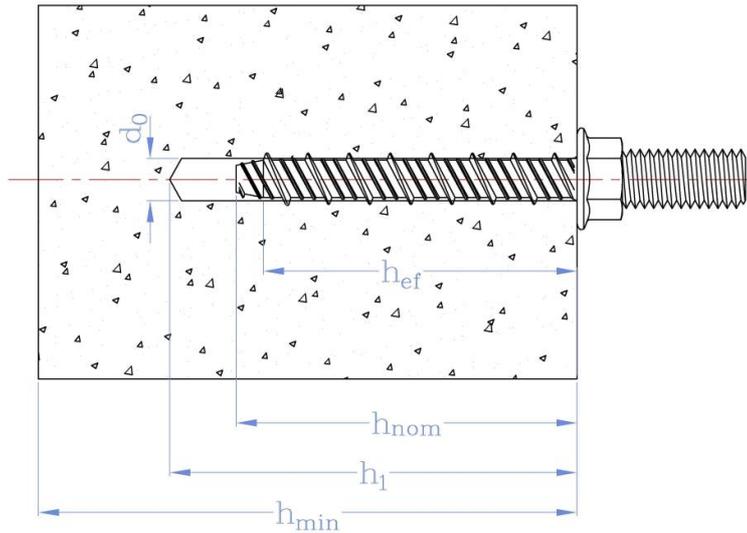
Condiciones de instalación para anclajes SSD, SSI, SSF, SSO, SSU, SSG, SSQ, SSV and SSG2 en bloques de hormigón
